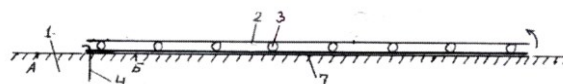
Схема укладки арматурного каркаса с каналами-трубами и полотнищами с сухой смесью Concrete Canvas на основание дороги: 1 – основание; 2 – арматурный каркас; 3 – полимерные трубы; 4 – костыль; 7 – полотнище Concrete Canvas
